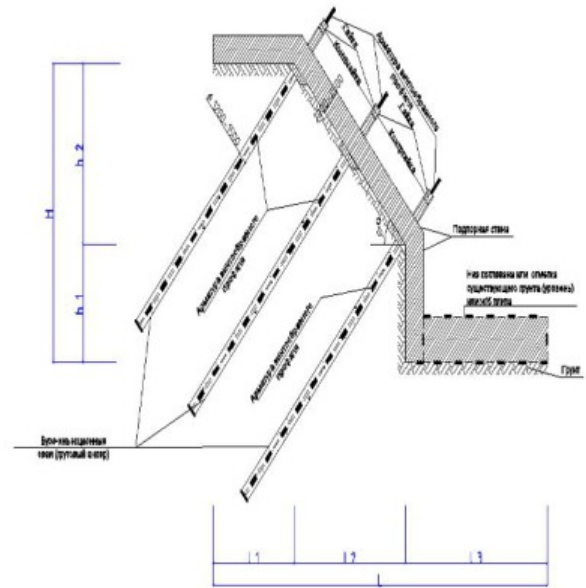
Поперечный разрез одевающих (прижимных) подпорных стен. Вариант II./ Cross section of clamping retaining walls. Option II.
